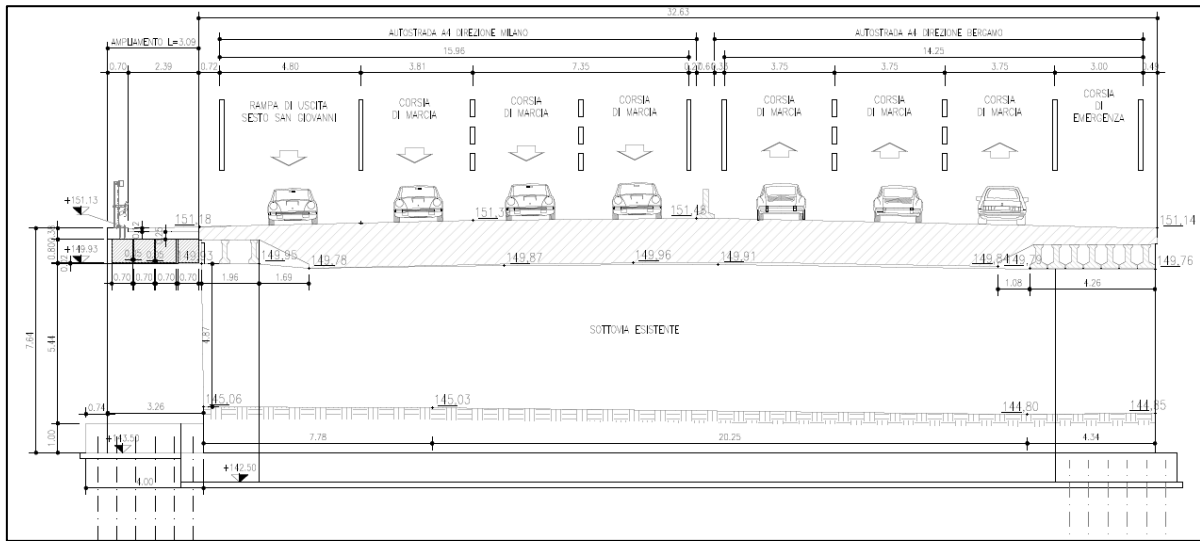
Sezione longitudinale lato Bergamo - OP1
